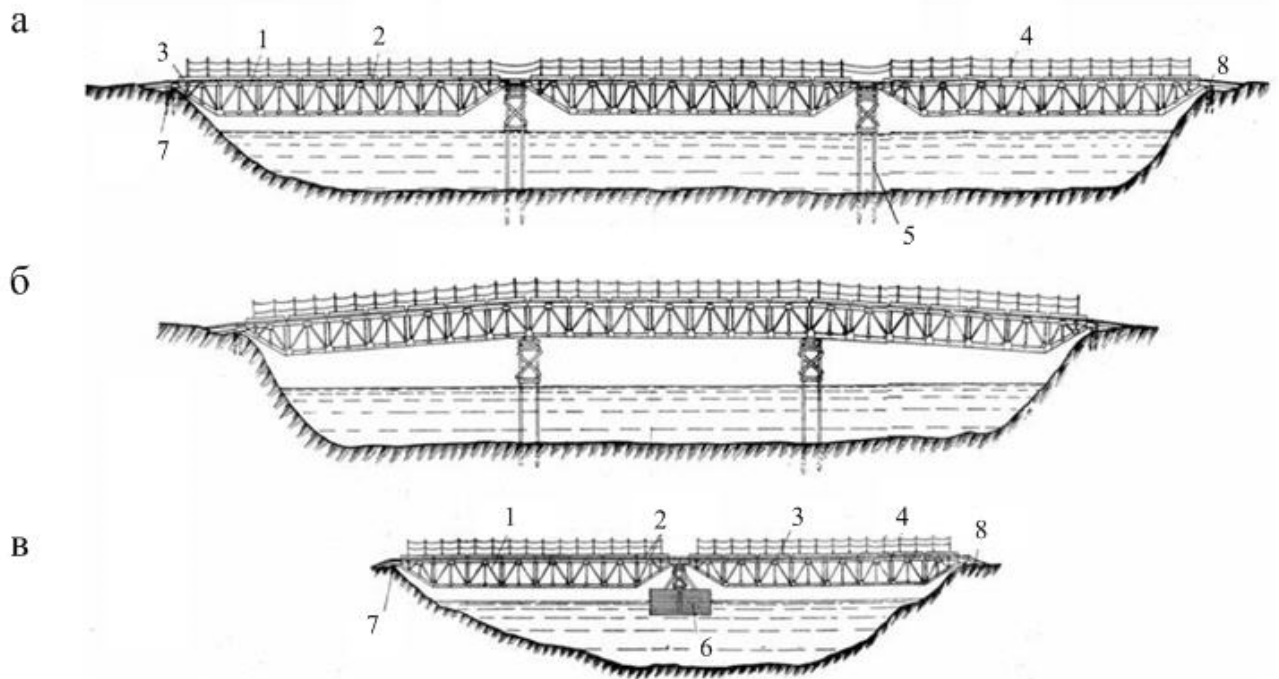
Схеми мосту із комплекту РММ-4: а, б – на жорстких опорах; в – на плавучих опорах: 1 – головні ферми; 2 – настилочні щити; 3 – колесобій; 4 – перильні стойки; 5 – проміжна опора; 6 – проміжна плавуча опора; 7 – береговий лежень; 8 - східні
